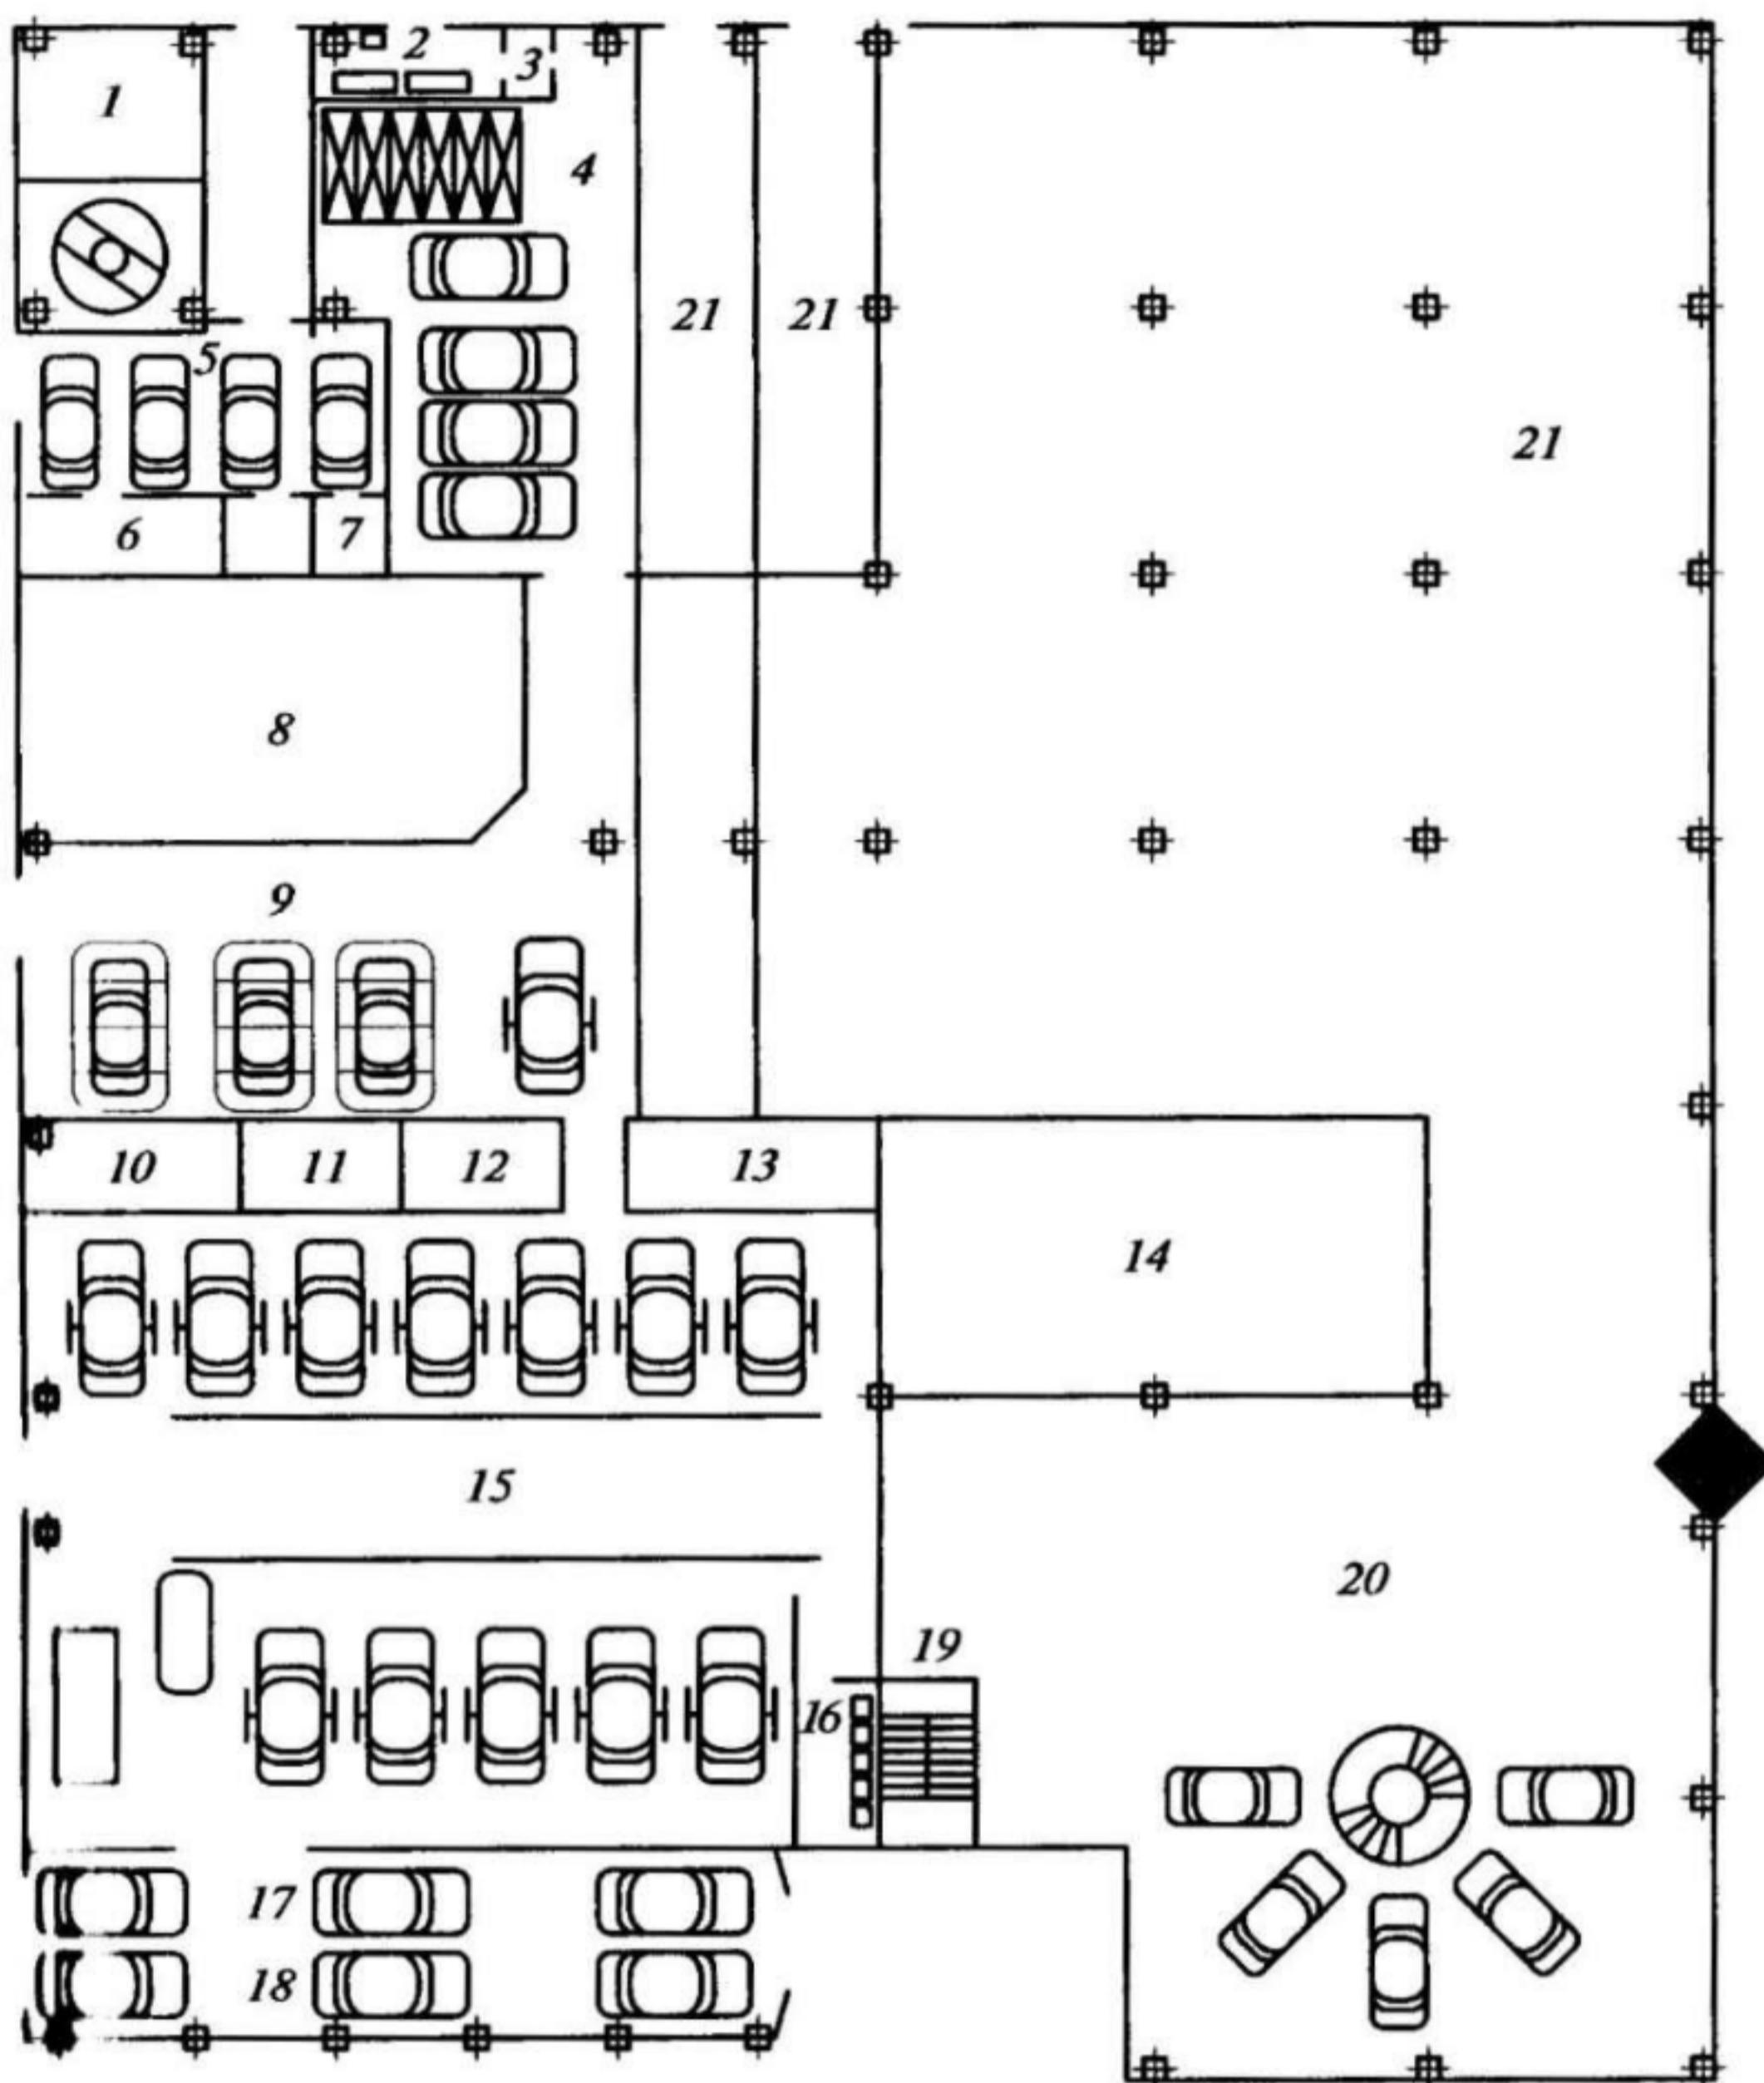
Планировка дилерской СТОА на 35 рабочих постов: Бытовые помещения; 2 — кладовая красок; 3 — краскоприготовительная; 4 — окрасочный участок; 5 — ТО и ТР погрузчиков; 6 — зарядная; 7 — компрессорная; 8- инженерный блок; 9 — сварочно-жестяницкий участок; 10 — кладовая масел; 11- шинный участок; 12— инструментально-раздаточная кладовая; 13— бытовые помещения; 14 — промежуточный склад; 15 — участок ТО и ТР автомобилей; 16 — шиномонтажный участок; 17 — линия мойки автомобилей; 18 — линия предпродажной подготовки автомобилей; 19 — административные помещения; 20 — выставка автомобилей; 21 — центральный склад
